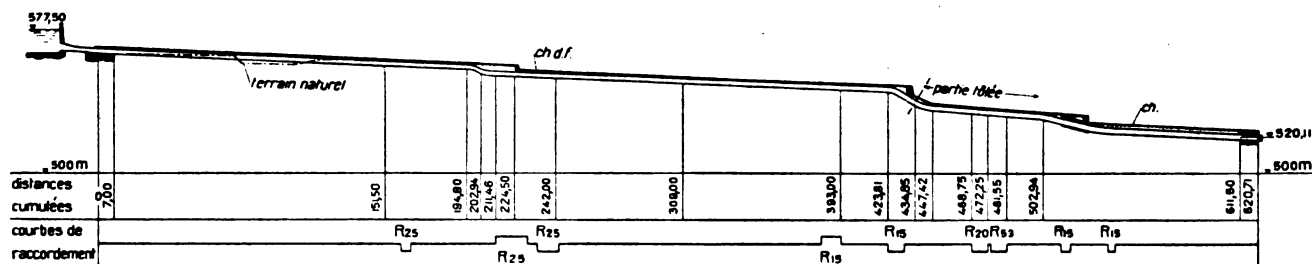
Profil en long de la conduite en béton armé. Pression statique max. 55,14 m. — Echelle des longueurs et des hauteurs 1 : 4000.
